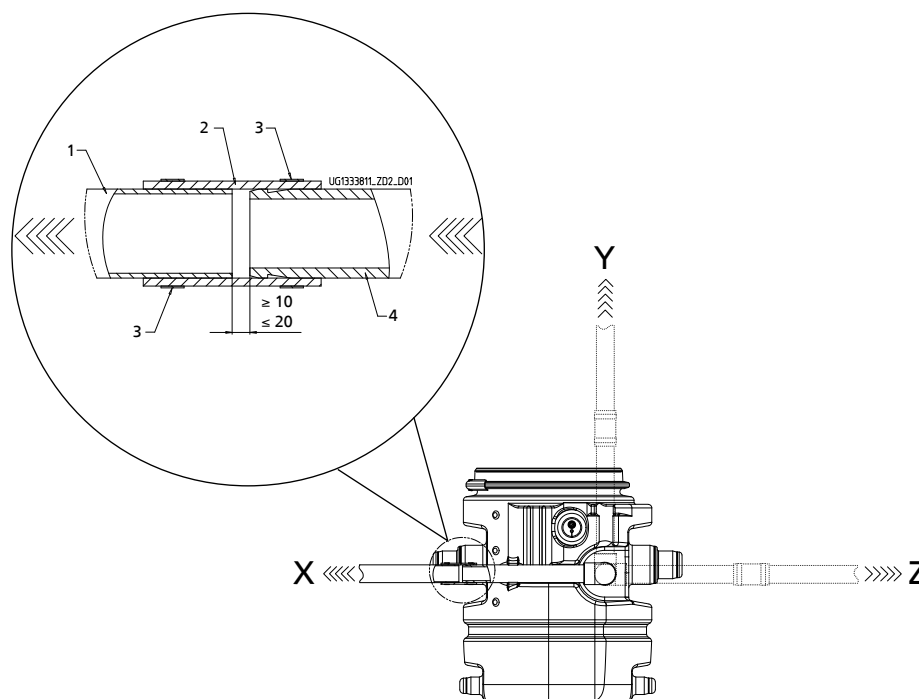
Montaje del tubo de impulsión y ajuste de la medida de montaje, dimensiones [mm]
